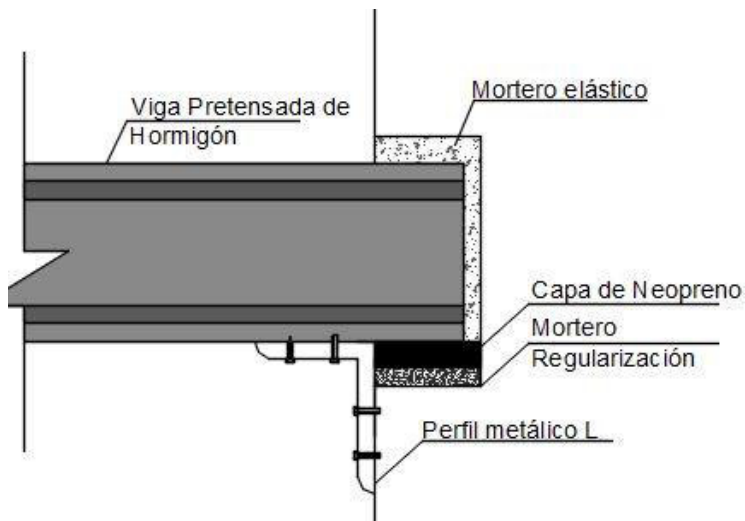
Detalle cajeadado viga con cerramiento. Fuente propia.
